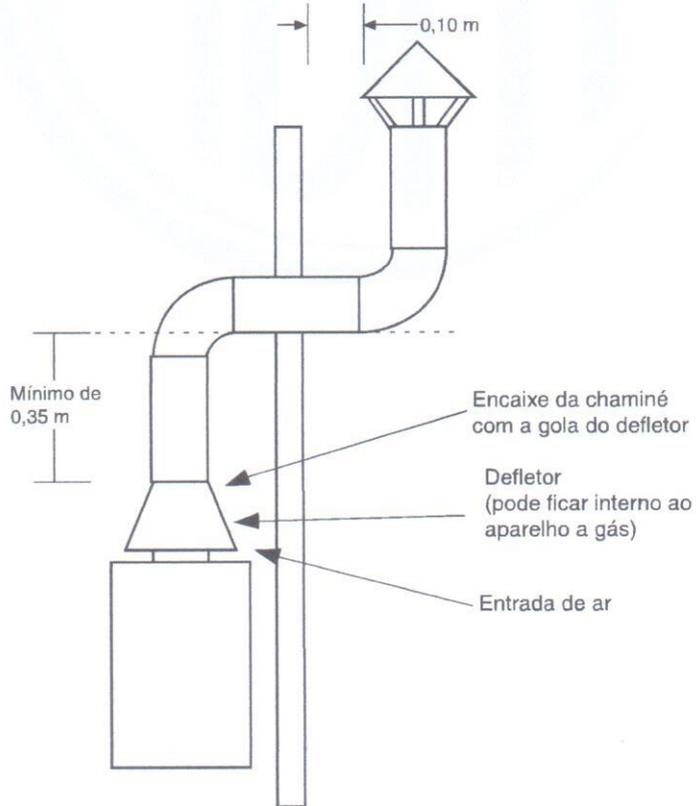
Terminal tipo chapéu chinês – Face da edificação
